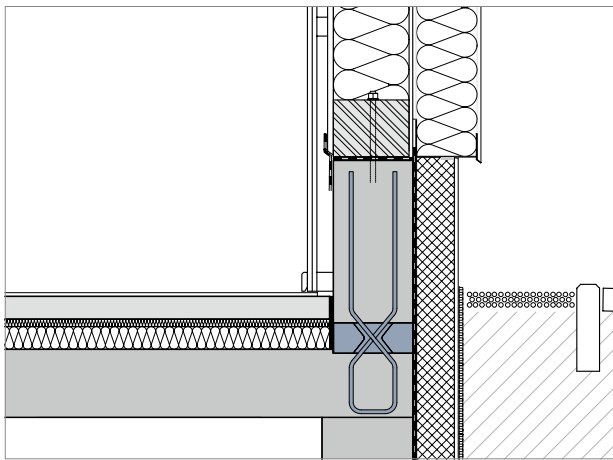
Betonsockel mit Schöck Sconnex® Typ W
